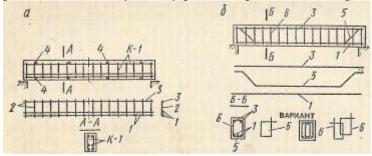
Схемы армирования балок сварными каркасами (а) и вязаной арматурой (б): 1 - продольные рабочие стержни (стержни второго ряда не доведены до опор); 2- поперечные стержни каркасов; 3- продольные монтажные стержни; 4- поперечные соединительные стержни; 5- рабочие стержни с отгибами; 6- хомуты вязаных каркасов.
